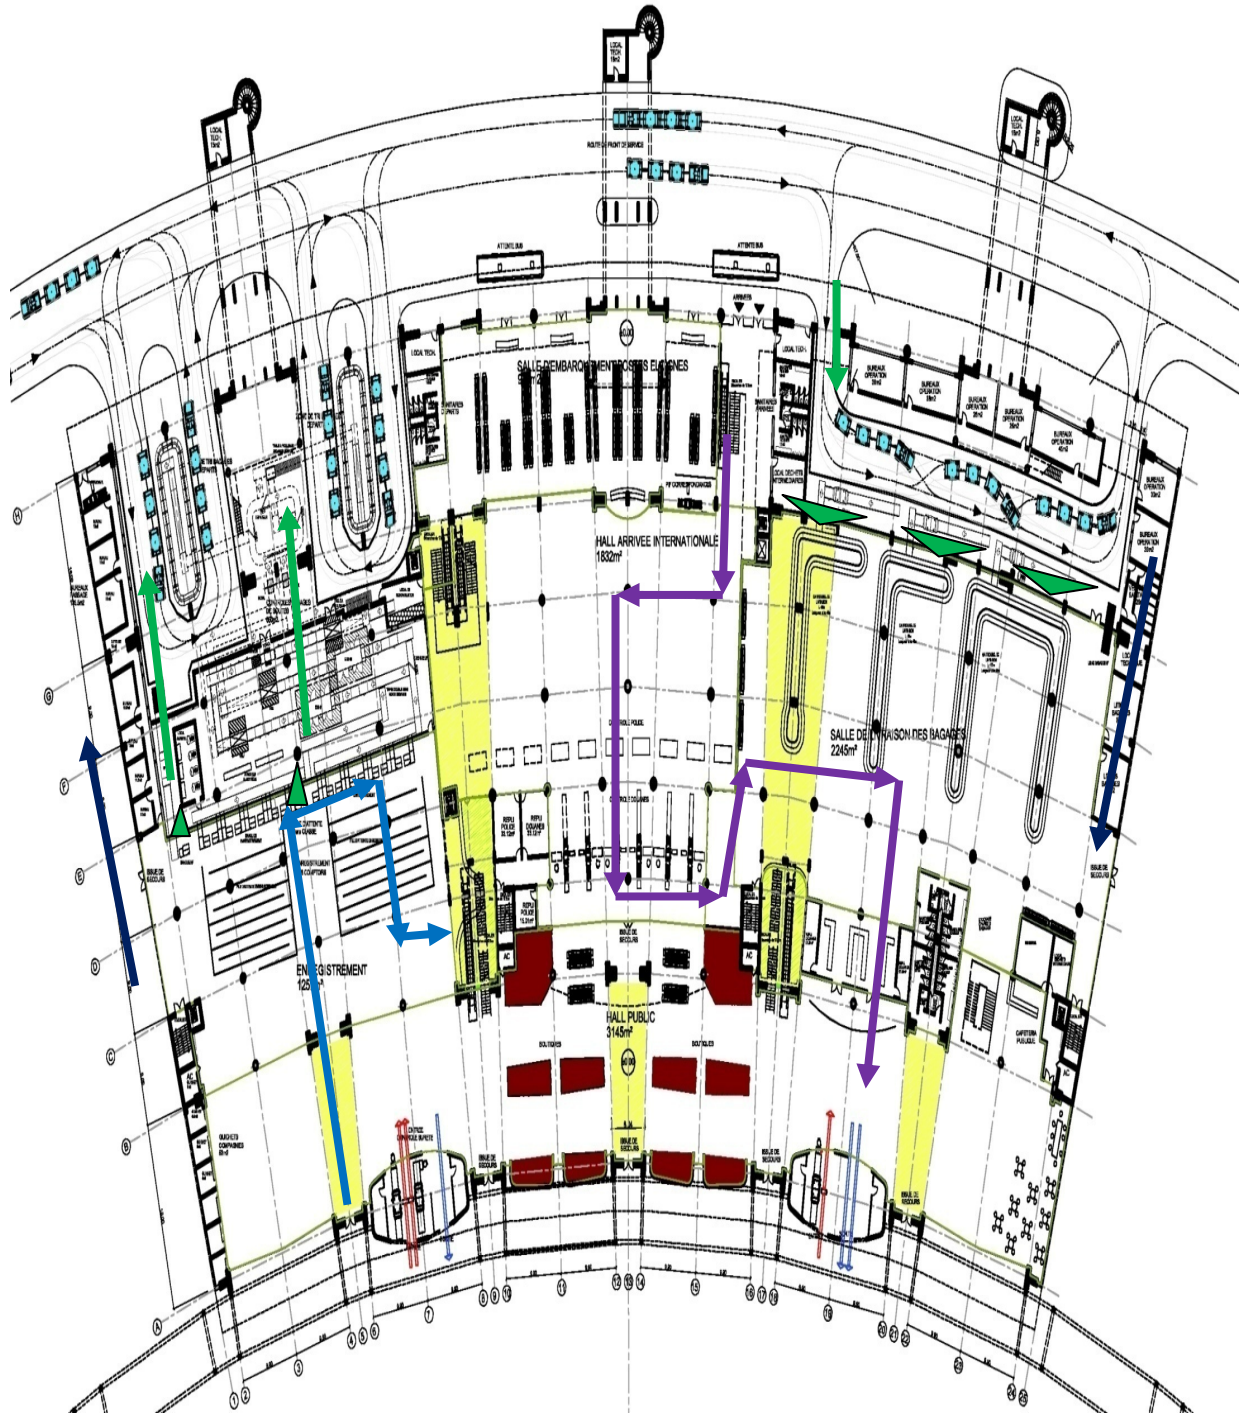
Cheminement passagers et bagages -Plan du rez-de-chaussée
